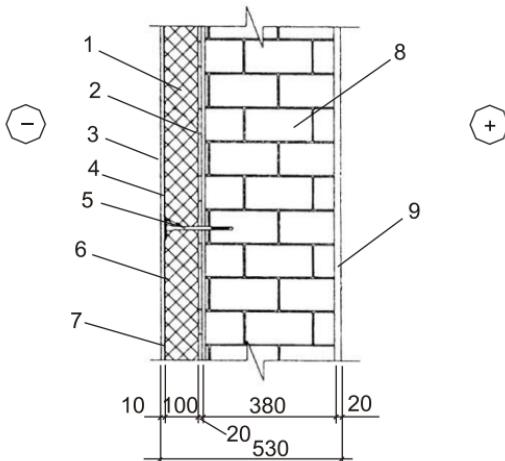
Утепление стены кирпичной кладки с применением для системы плит PAROC FAS-4: 1 — PAROC FAS 4; 2 — клей; 3 — отделка; 4 — грунтовка; 5 — деталь крепления каменной ваты; 6 — выравнивающий слой армирования; 7 — сетка арматурная; 8 — кирпичная кладка; 9 — внутренняя штукатурка
